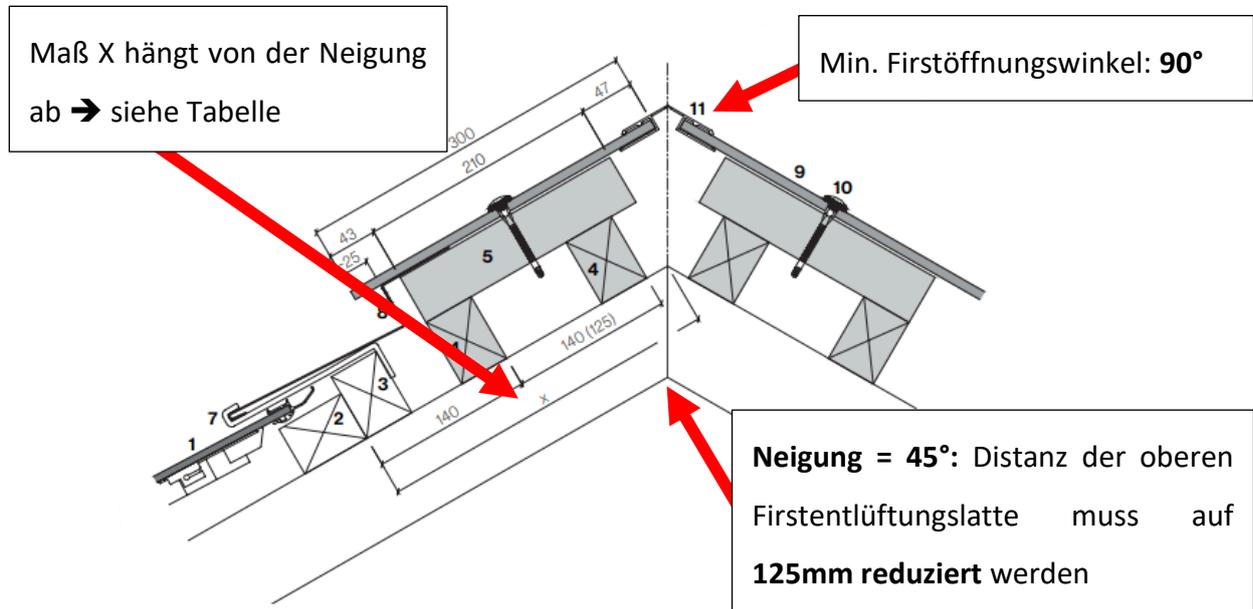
Firstdetail (Quelle: Swisspearl Details Sunskin Roof Lap)
